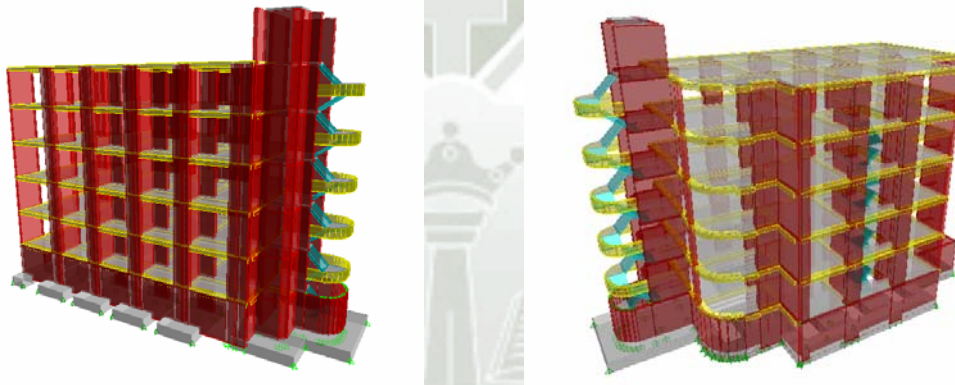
Vista en 3D del Modelo Estructural.
